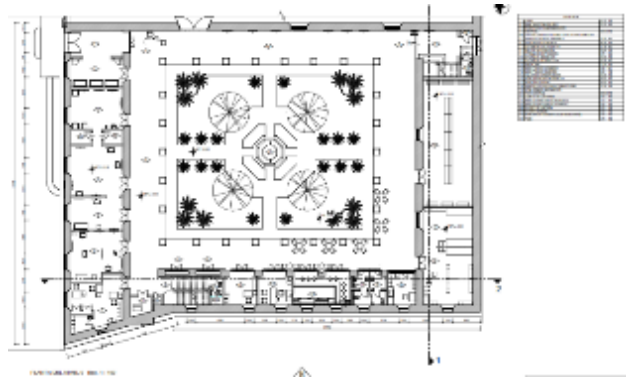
Plantas arquitectónicas propuestas por niveles. (3)
